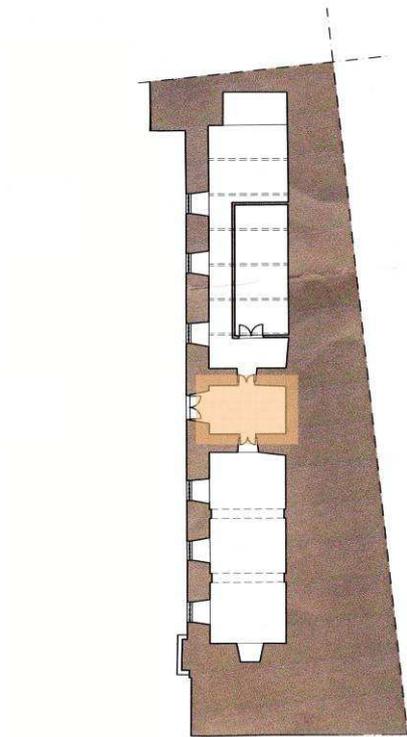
Localização da sala do centro na planta do criptopórtico do levantamento de 2003.
